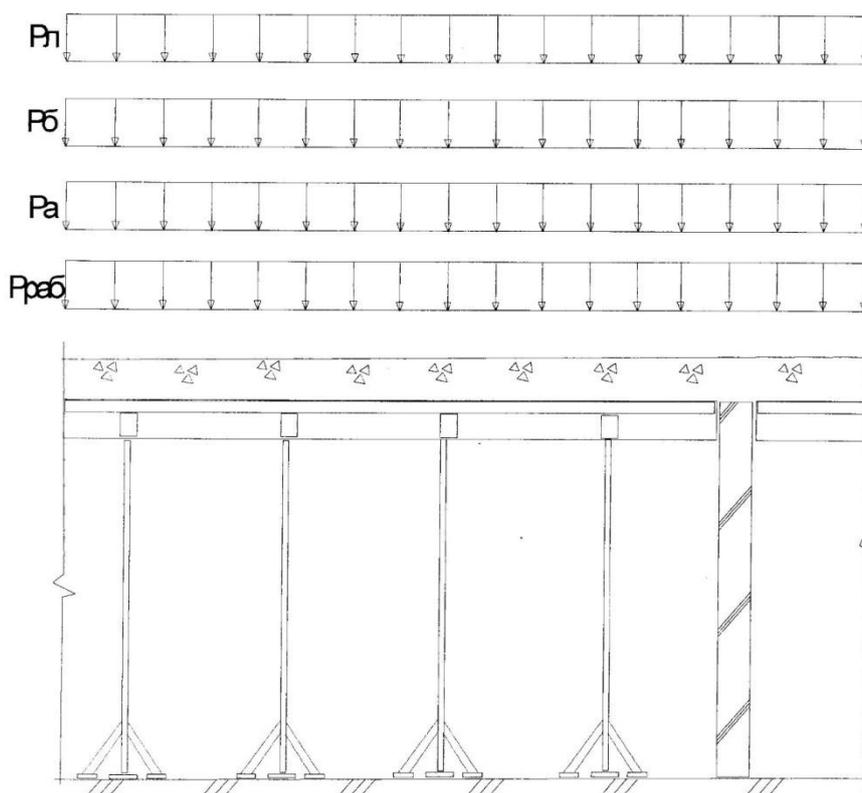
Расчетно-конструктивная схема опалубки перекрытия
